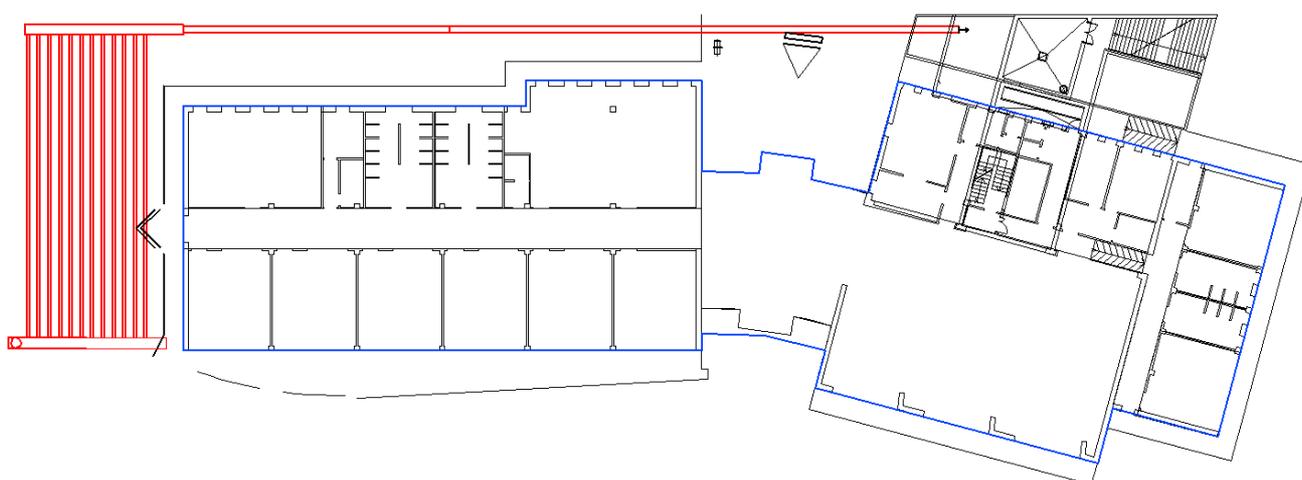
Scuola 'Stroppari' pianta e tubazioni EAHE.
